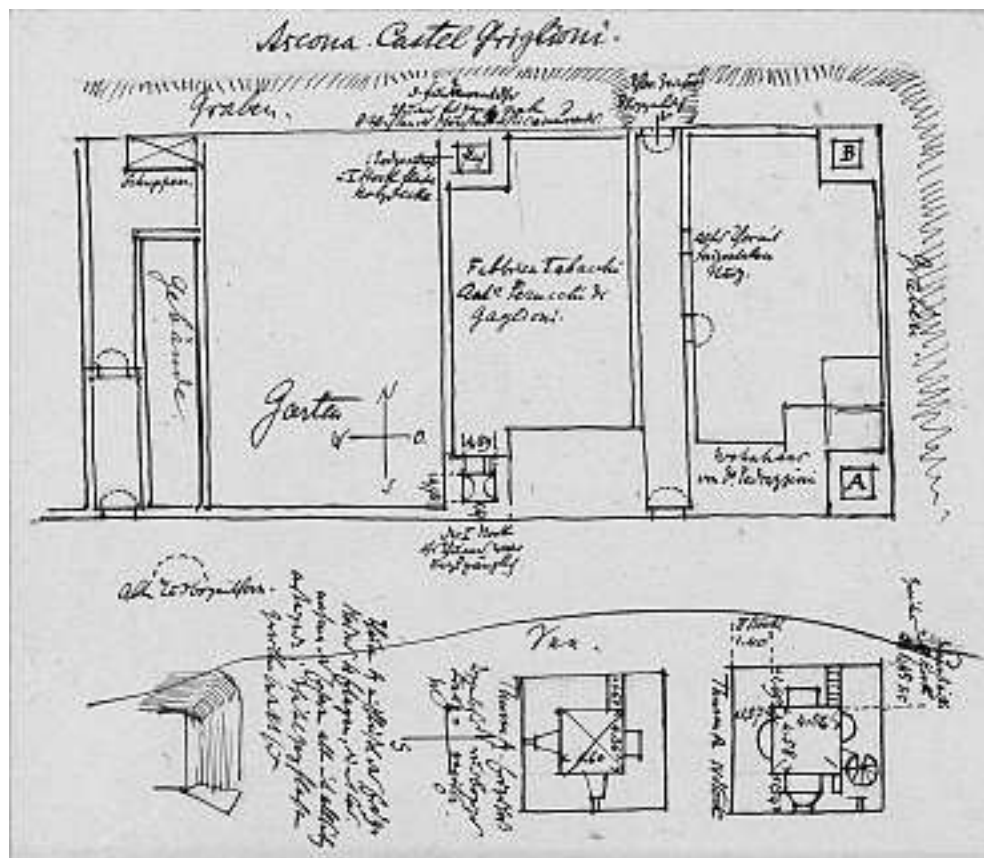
Ascona, Cast. dei Grigioni. Grundrissplan von Johann Rudolf Rahn (1889).
